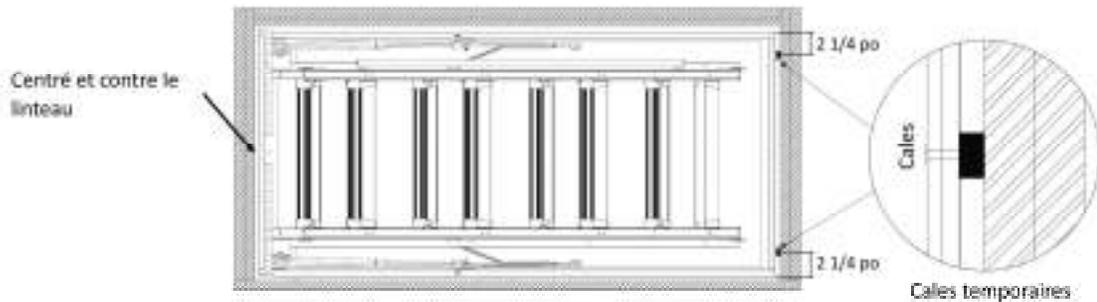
INSTALLATION DES CALES AU NIVEAU DES PIEDS
